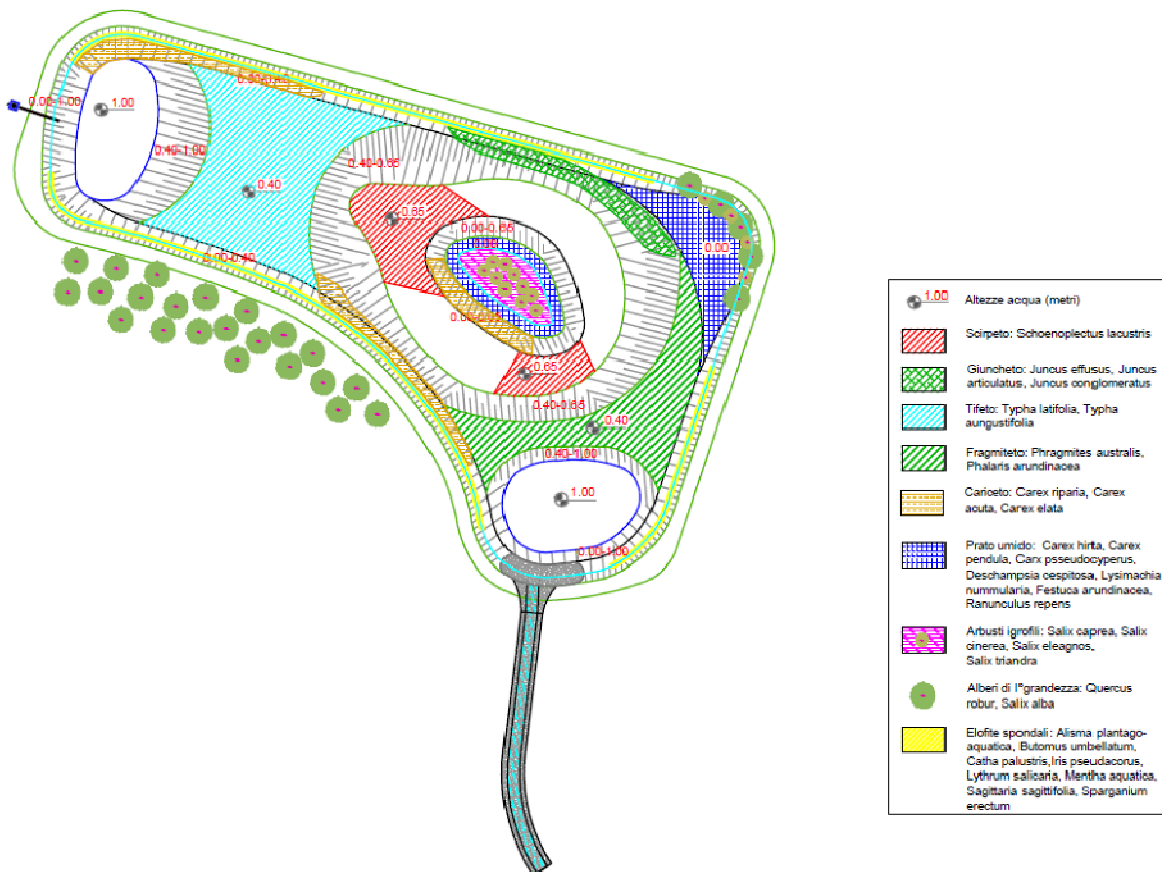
Planimetria della zona umida presente all'interno della cassa di espansione
